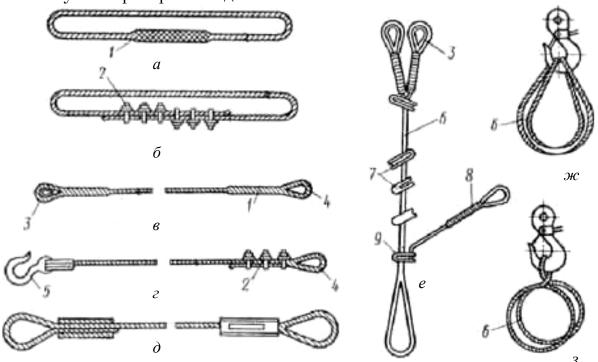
Универсальные (а, б) и облегченные (в, г, д, е) стропы и схемы подвески на крюк универсальных строп (ж, з): 1 – заплетка; 2 – сжимы; 3 – коуш; 4 – петля; 5 – крюк; 6 – строп; 7 – прокладка; 8 – тяговый тросик; 9 – полуавтоматический захват
